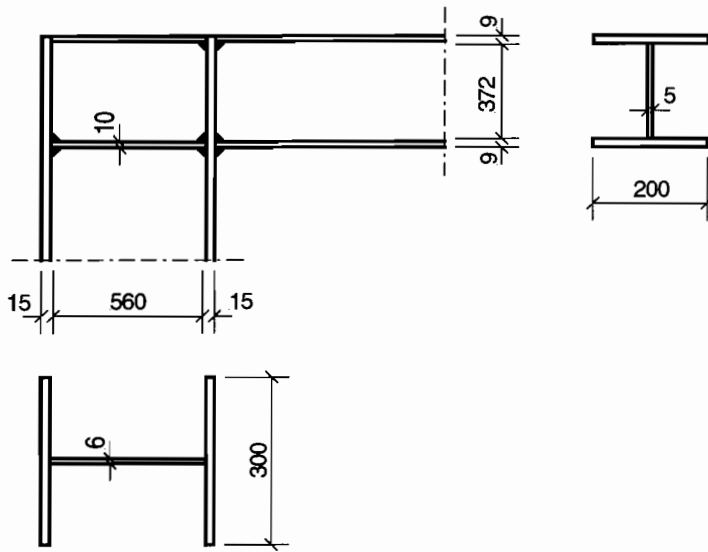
Verbindung Schweiss-schlank
